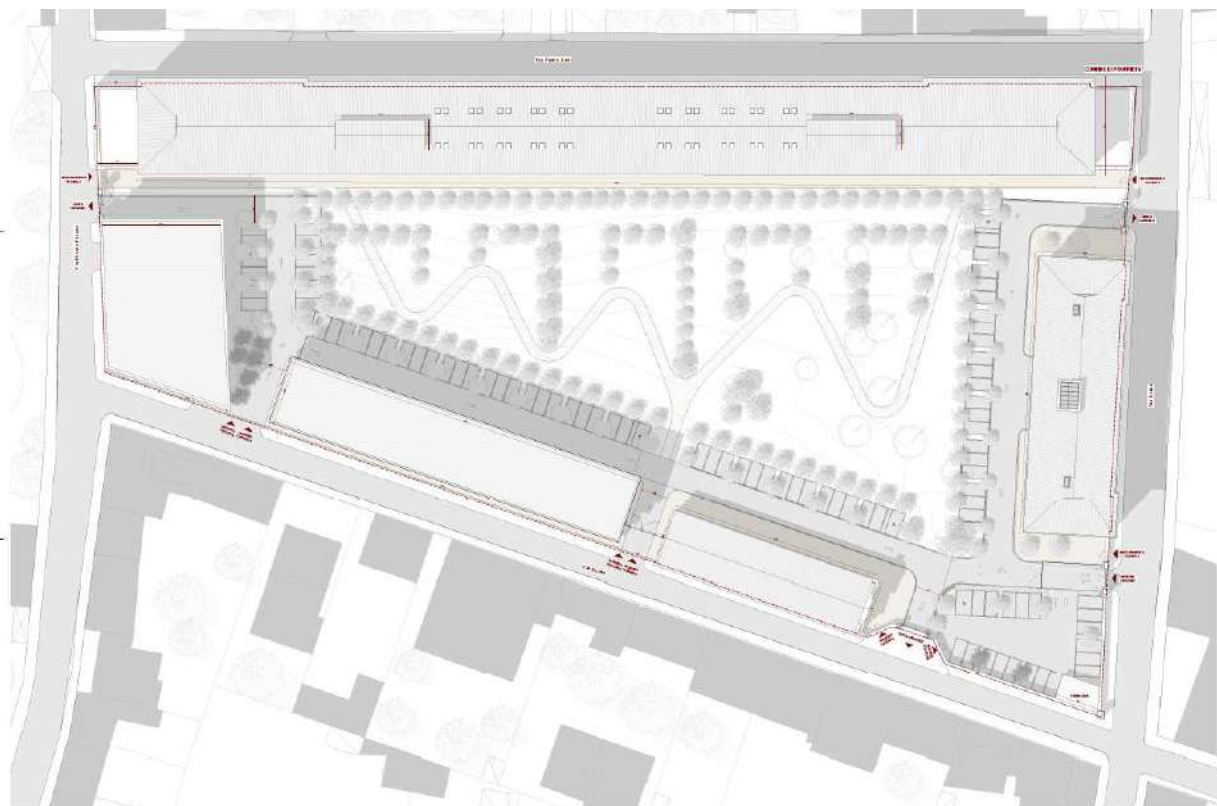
Planimetria generale delle coperture (Estratto da Tav. PdR PR.AR.03.01.R2)
